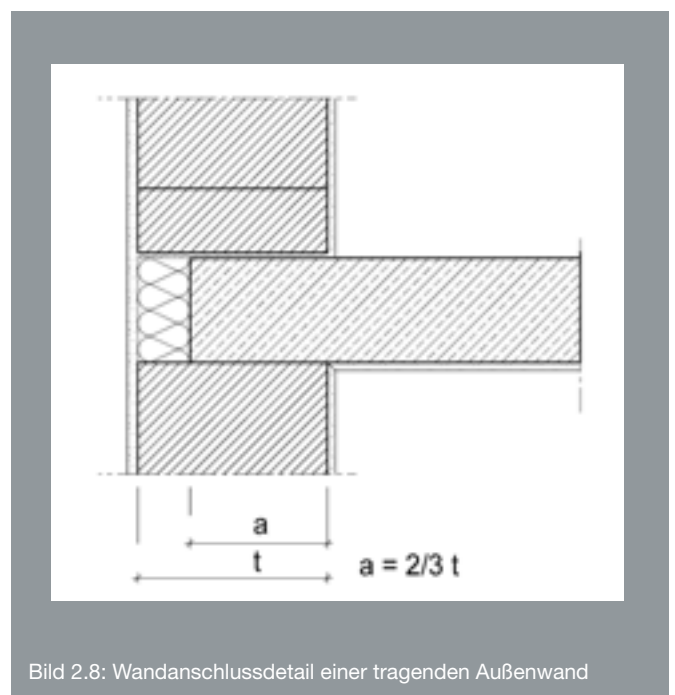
Wandanschlussdetail einer tragenden Außenwand
